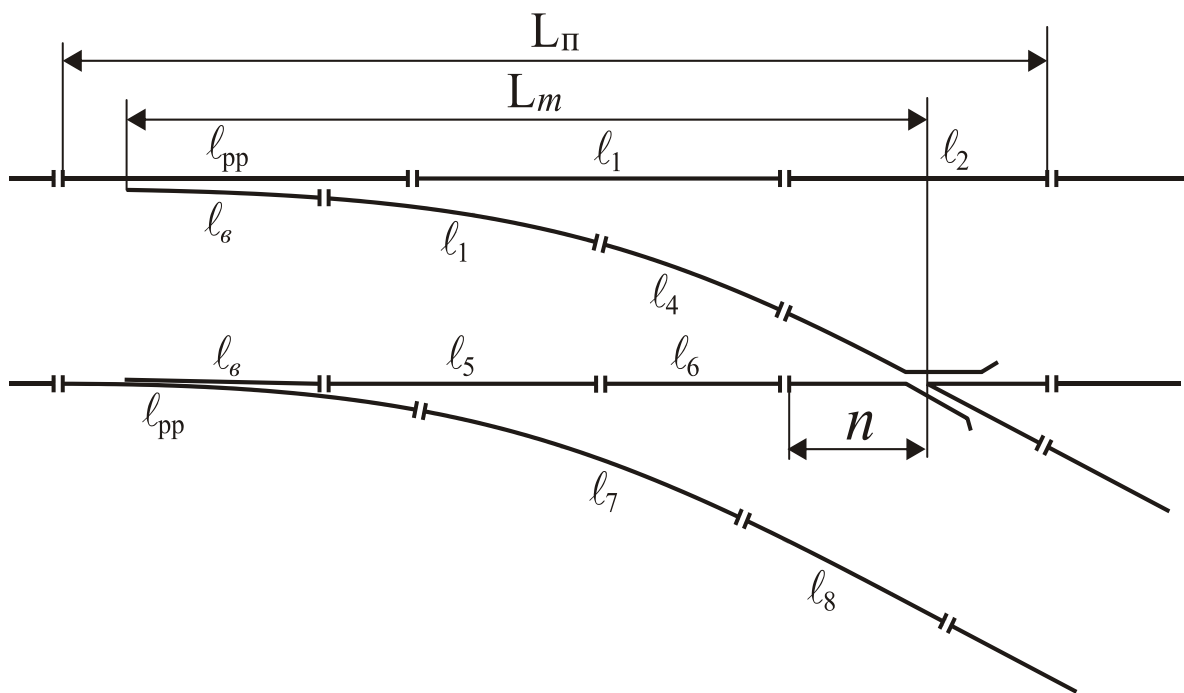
Розрахункова схема для визначення довжини рейок з'єднувальних колій
